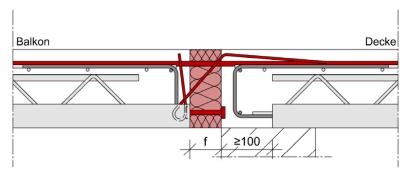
Einbau Egcobox in Elementdecken – Bügel im Elementdeckenspiegel einbetoniert
